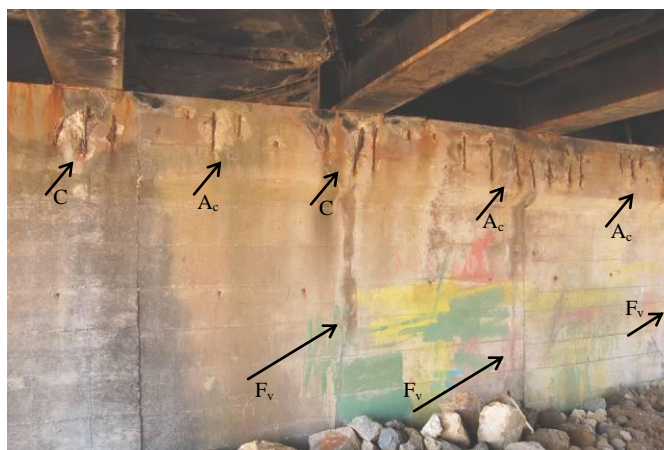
Degradação do betão armado em menos de metade da área exposta do pilar parede 3 (PP3), ocorrendo na zona de espessamento e no restante comprimento visível do pilar. Viaduto 4/5
